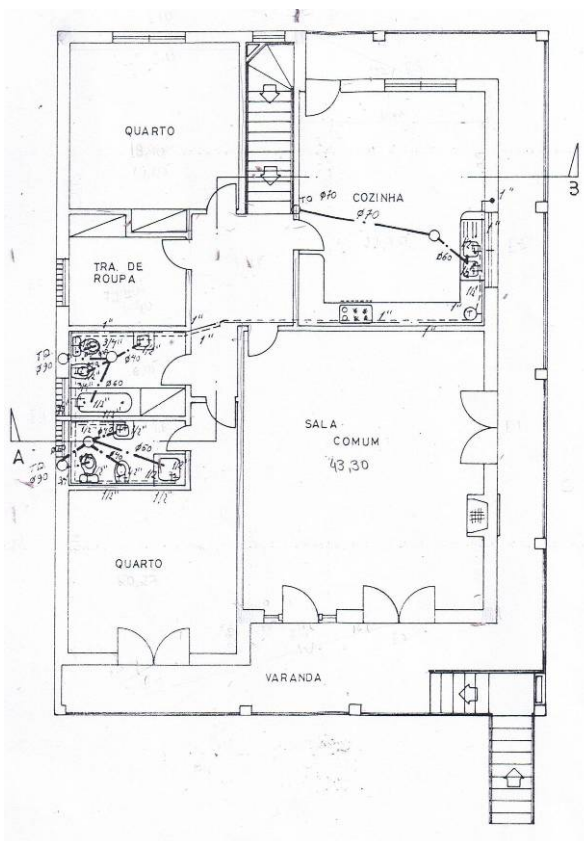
e 24 – Planta do 1º Andar e Corte, projecto de arquitectura do Edifício E
